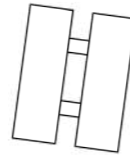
Situaciones de enfrentamiento de blocks enumerados en planta
